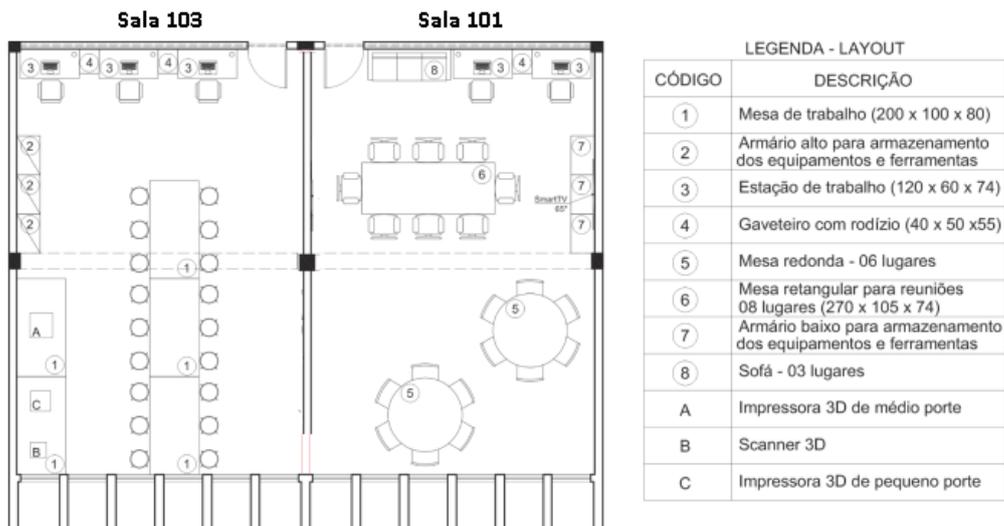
Planta baixa as built e infraestrutura existente nas salas selecionadas para a instalação CEFETMaker grassroots do Campus Varginha.
